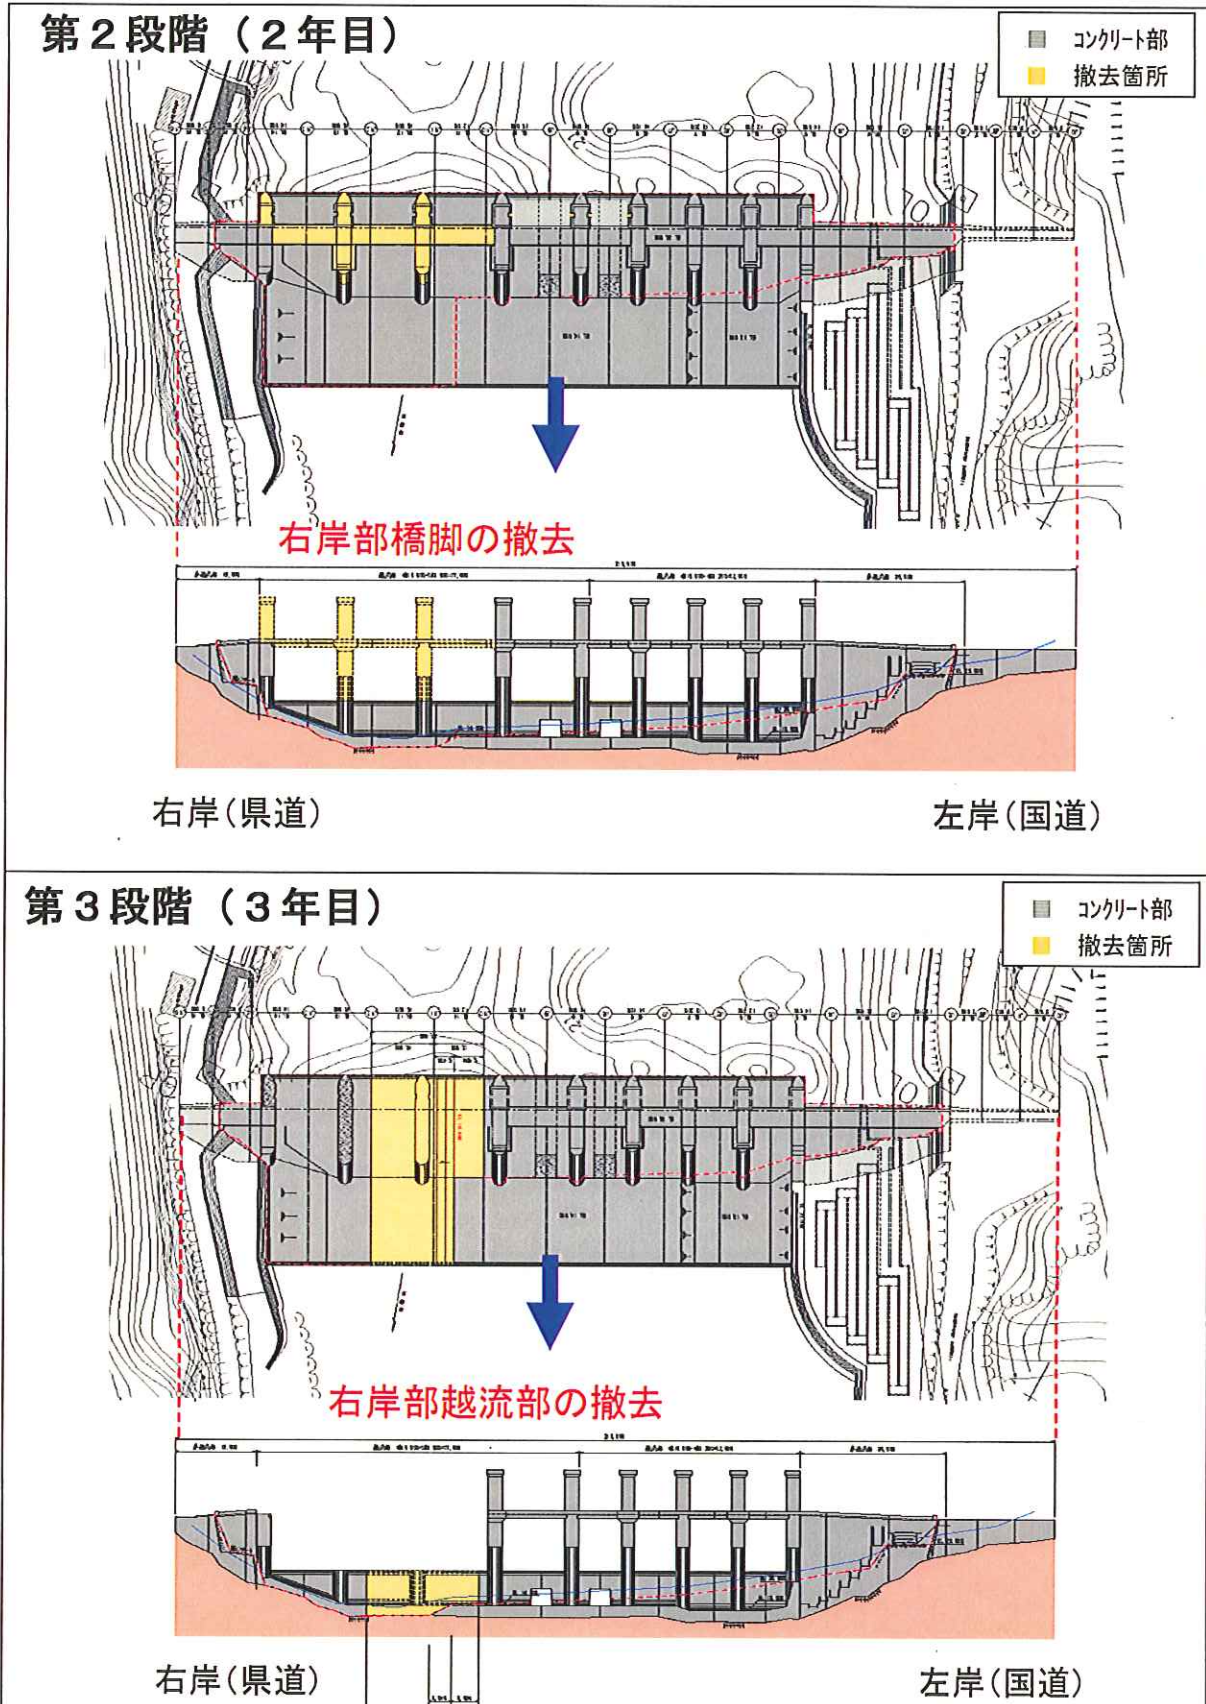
(2) 撤去計画平面図、下流面図 (第 2、3 段階)
